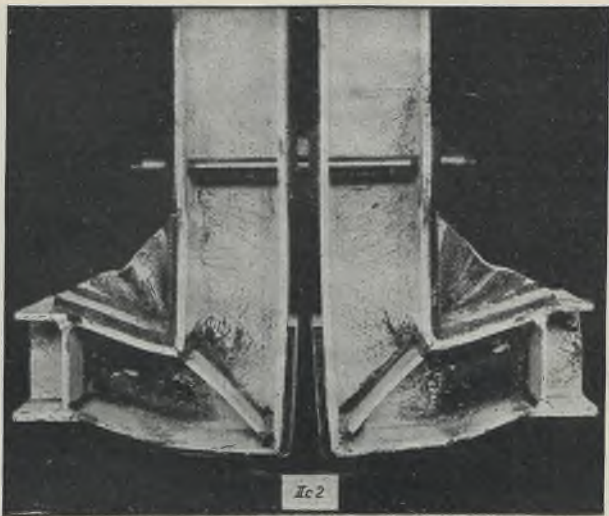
Versuch  $Ic_2$ , Steifrahmenecke mit Flanschlinsen, Eckaussteifung „E“. Laststufe 93,1 t = Bruchlast. Die Eckbleche „E“ sind ausgeknickt, der Träger über die Fließgrenze beansprucht und stark deformiert. Alle Schweißnähte sind intakt!
